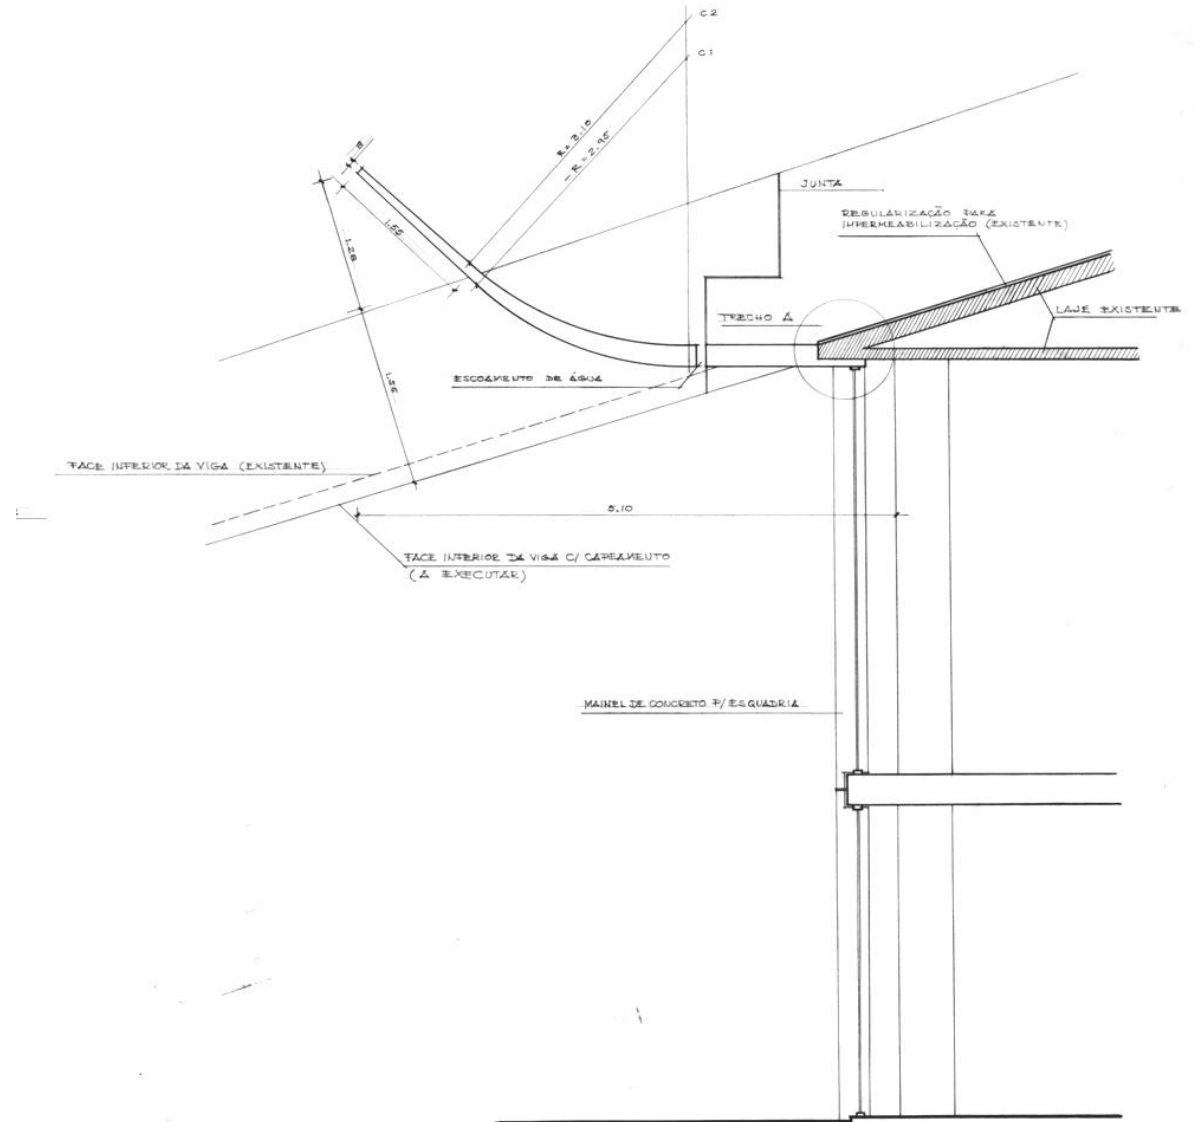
Detalhe - Corte Longitudinal/Detalhe (1968). Carimbo: Teatros Oficiais no Setor Cultural Norte, TOSC, DD 28.2. Conteúdo: Detalhe da laje na fachada oeste. Desenho: Igor. Data: 19/04/1968. Fonte: ARPDF.
